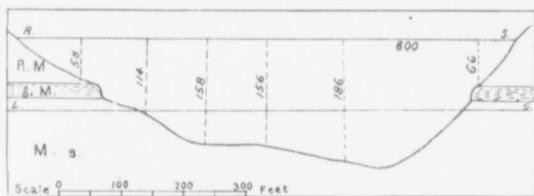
Coupe au pont d'Arche d'en Haut.
